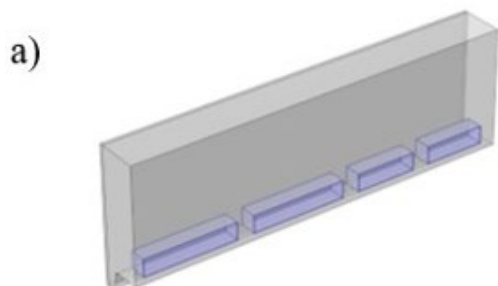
Угловой термовкладыш, установленный в наружный угол плиты перекрытия
